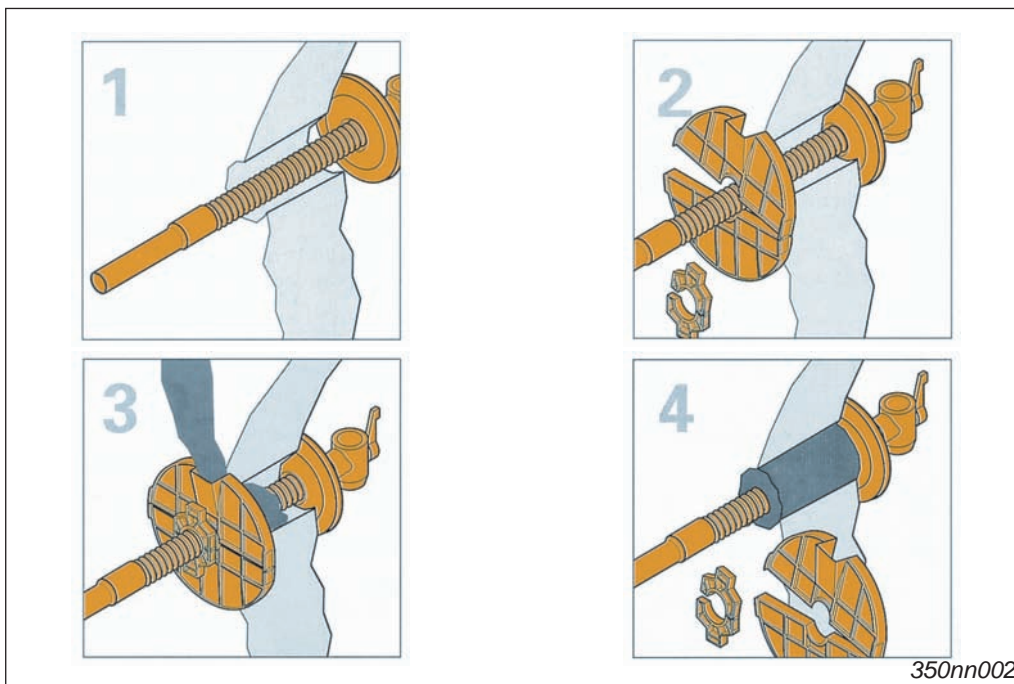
Einbaubeispiel Schuck-Beto-Fix/Schuck-Sani-Fix beim Einbau einer Gashauseinführung
